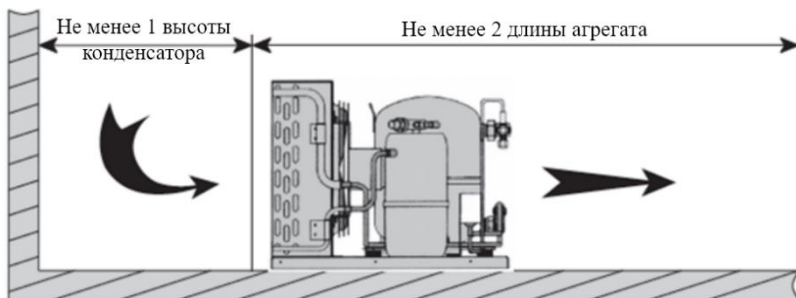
Требования к размещению компрессорно-конденсаторного агрегата
